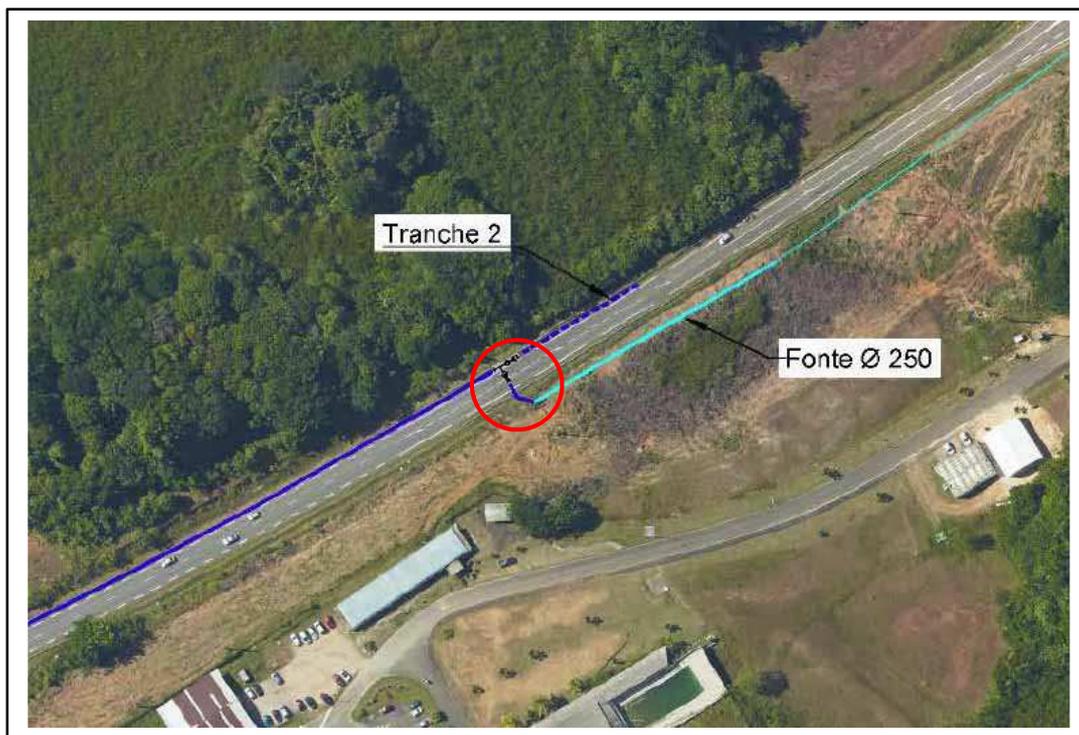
Raccordement à la conduite DN 250 sur la route de la Distillerie - SECOTEM
